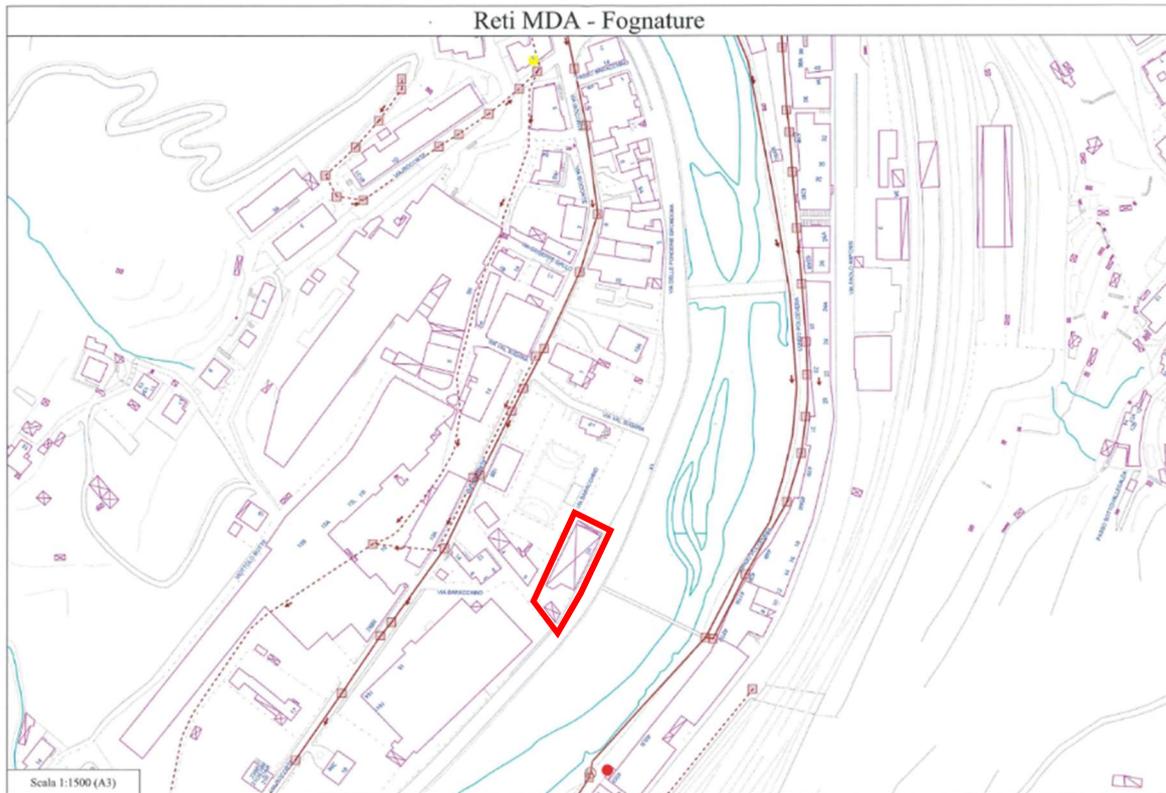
Stralcio planimetrico reti fognarie (IRETI)
